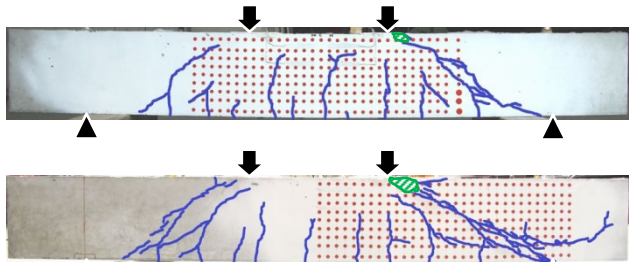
供試体のひび割れ性状（上：R-10 下：R-03）
